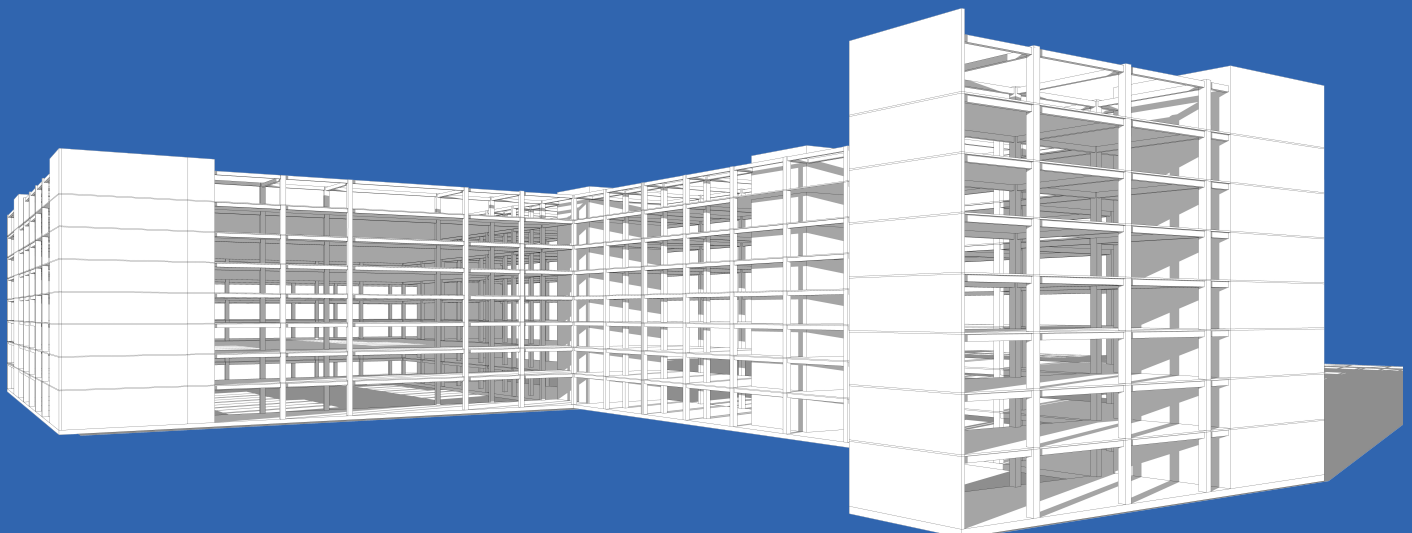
Vista esquemática de la estructura del proyecto utilizando muros de hormigón armado para las circulaciones verticales y madera para el resto de la
